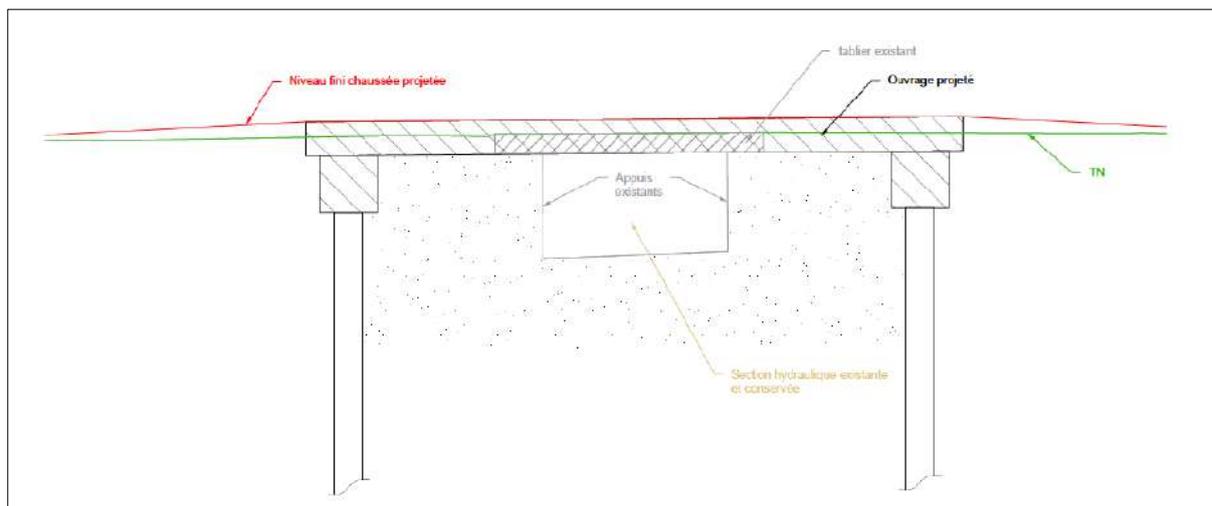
Coupe des travaux du pont au niveau du Camping de la Pierre verte
